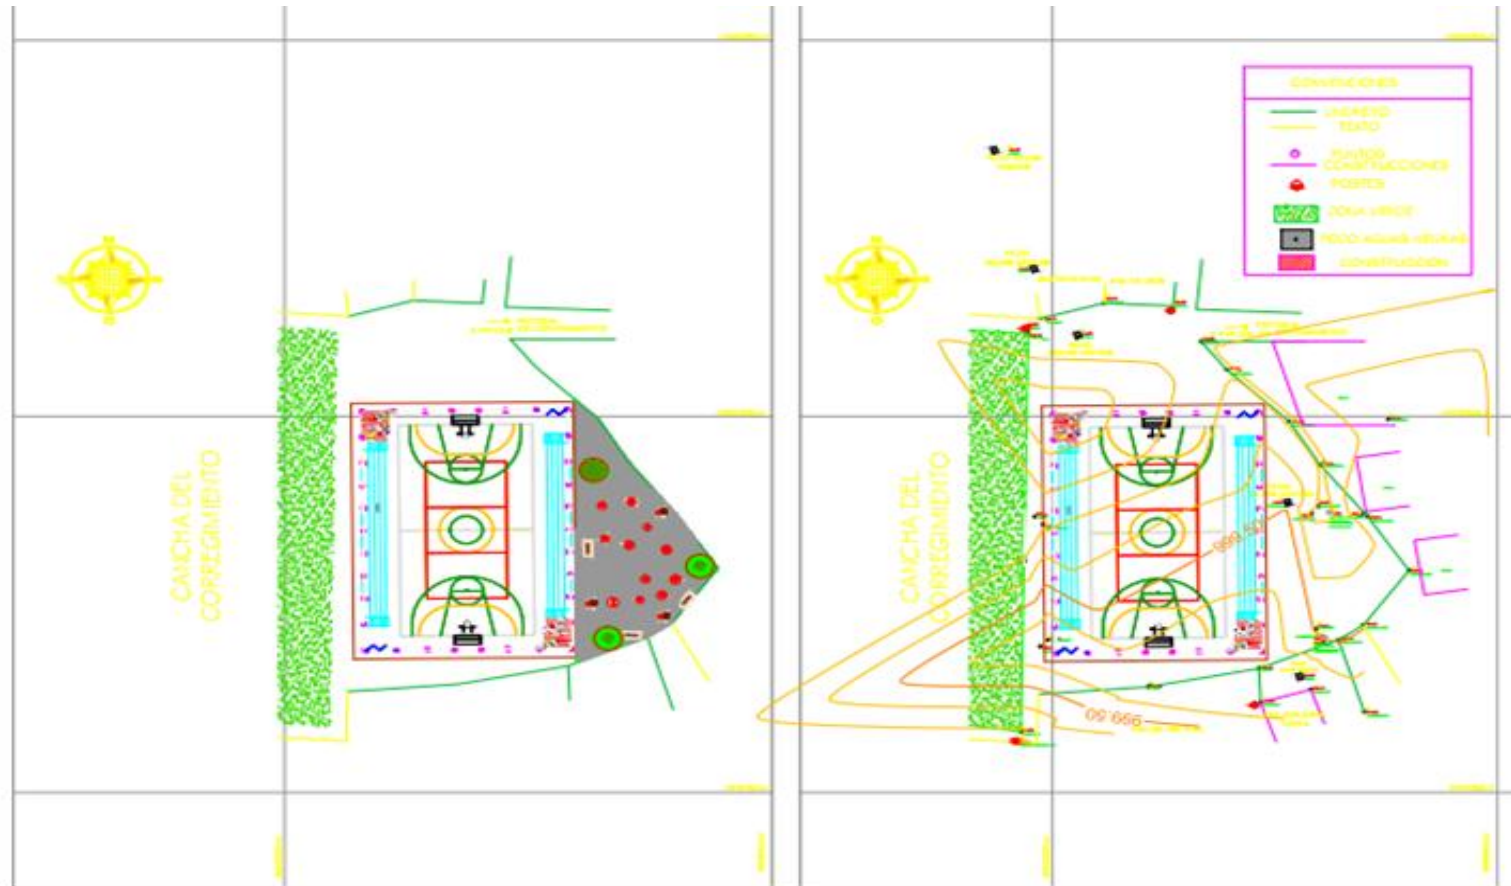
Plano de detalles Arquitectónicos Coliseo
